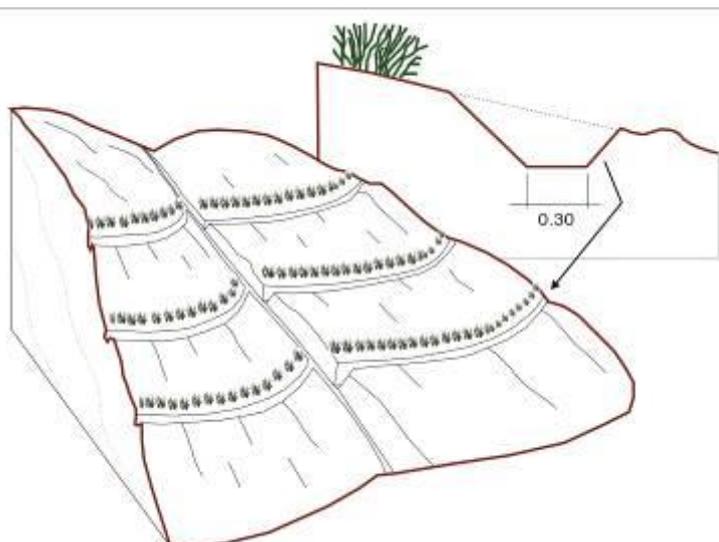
Sistema de drenaje en laderas ocupadas por cultivos
